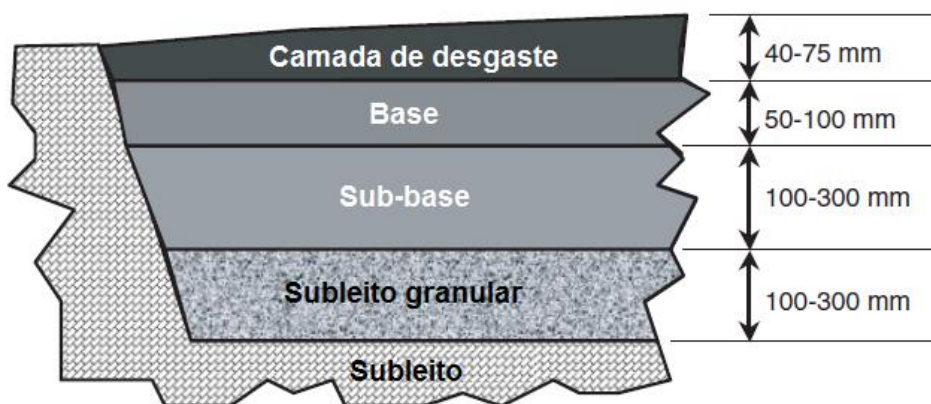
Esquema de seção transversal do pavimento. (JENK *et al.*, 2011)
